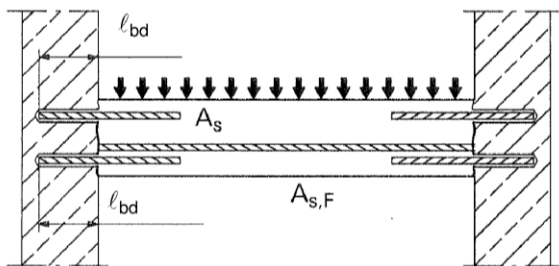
Bewehrungsanschlüsse überwiegend auf Druck beanspruchter Bauteile
